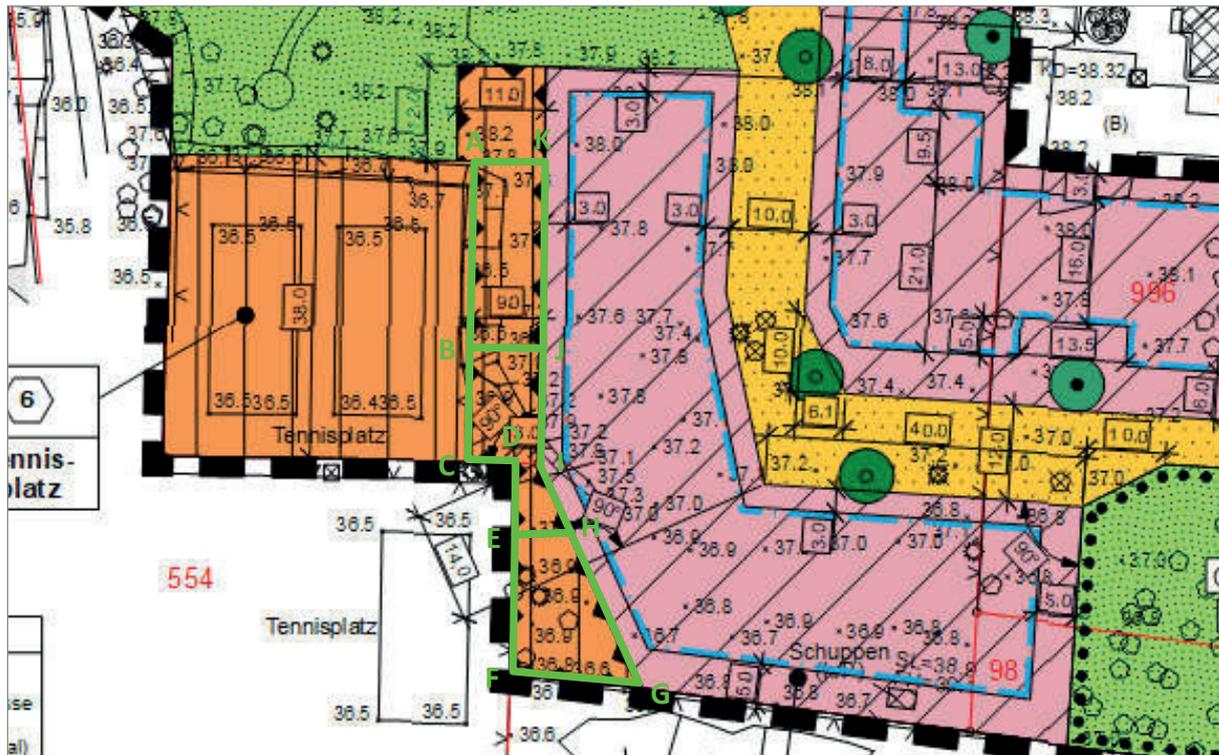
Entwurf zum B-Plan »Schwanenweg« | Bezeichnungen zum Festsetzungsvorschlag
